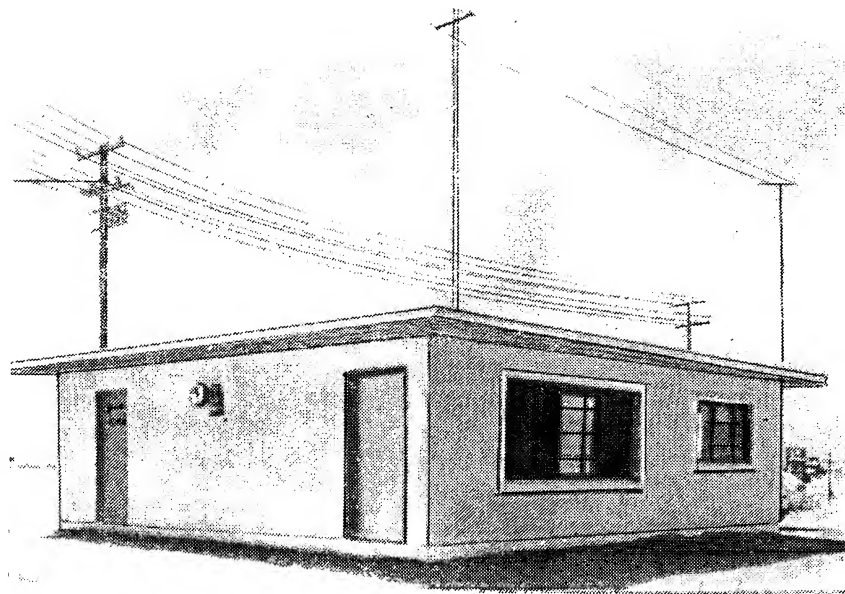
Дом усиленной конструкции из бетонных блоков до ядерного взрыва на полигоне в штате Невада
